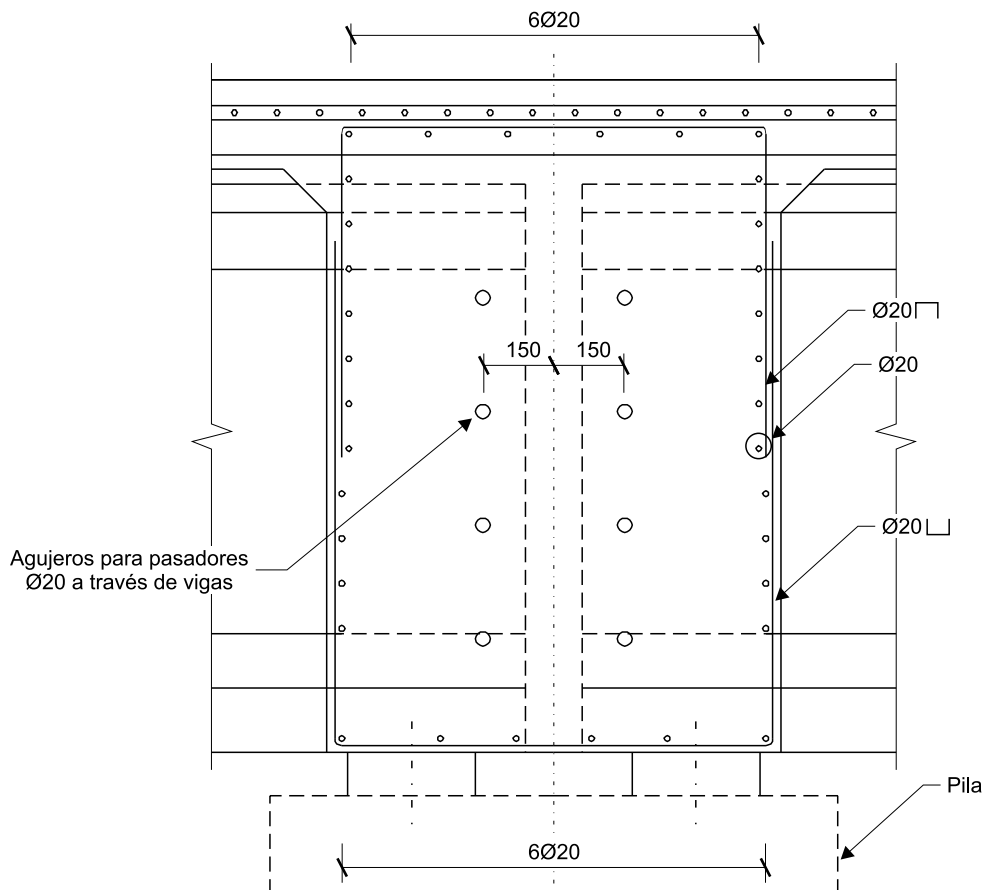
Detalle de continuidad estructural para tableros de vigas prefabricadas
